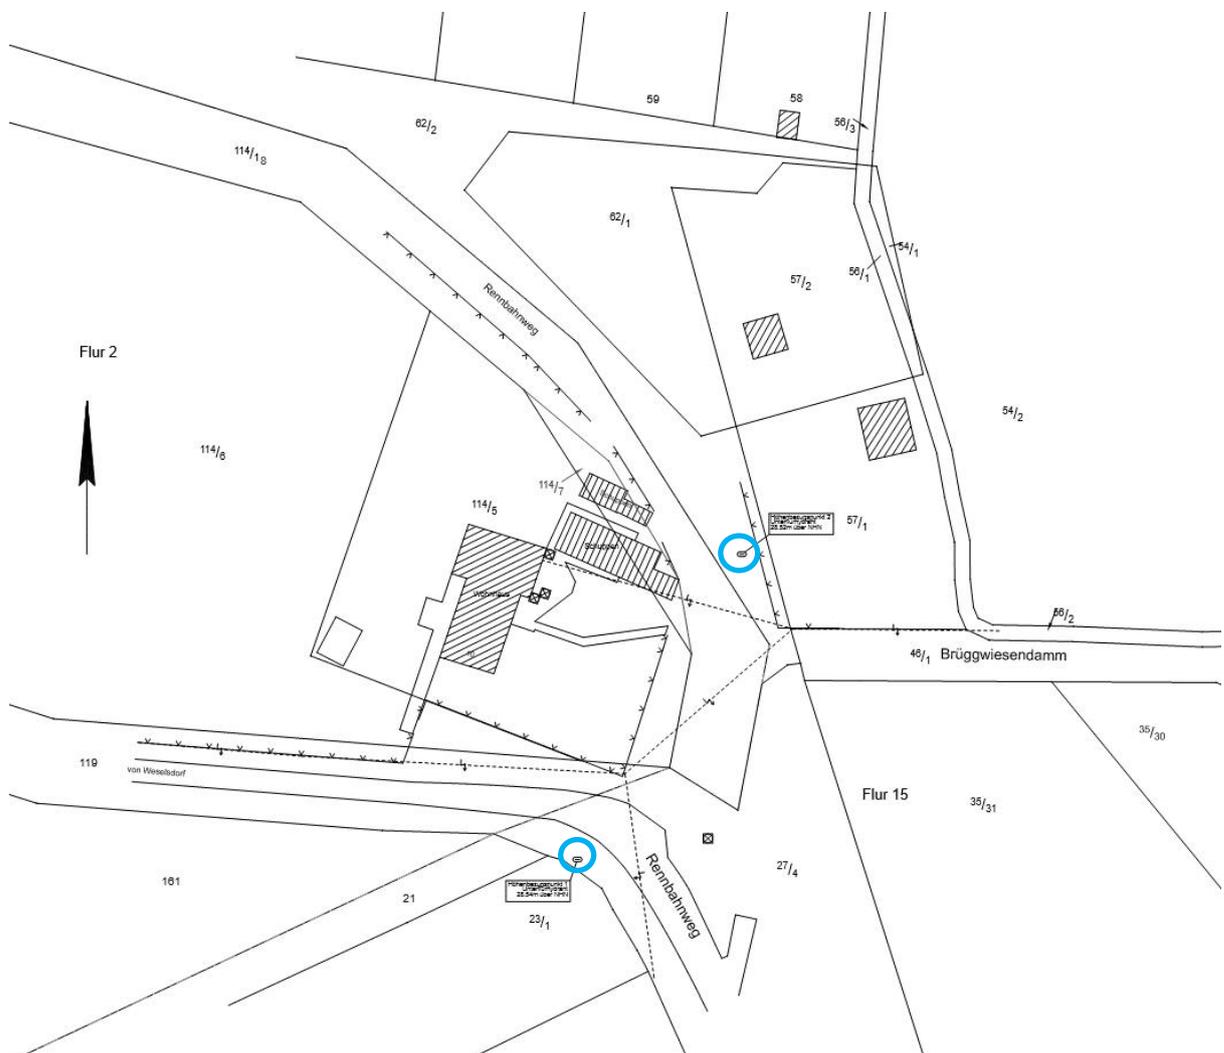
Auszug aus dem Lageplan des Vermessers mit blau markierten Löschwasserentnahmestellen, Stand 02/2024
